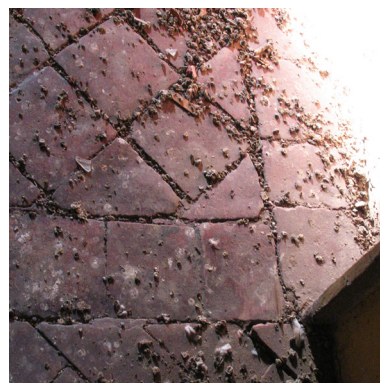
Tipo P25. Pavimento delle sale nobili della casa torre.
